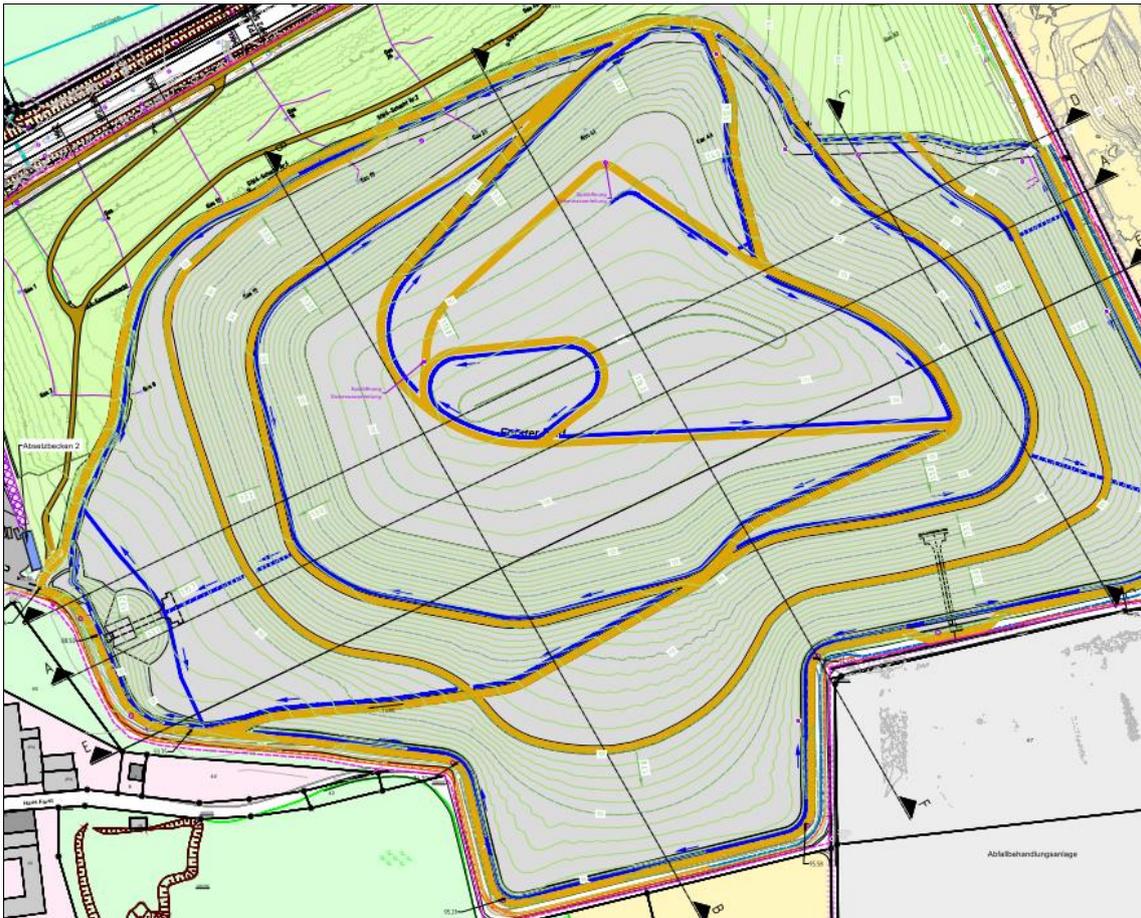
Lageplan endrekultivierte Deponie mit Lage der Prinzipschnitte.
